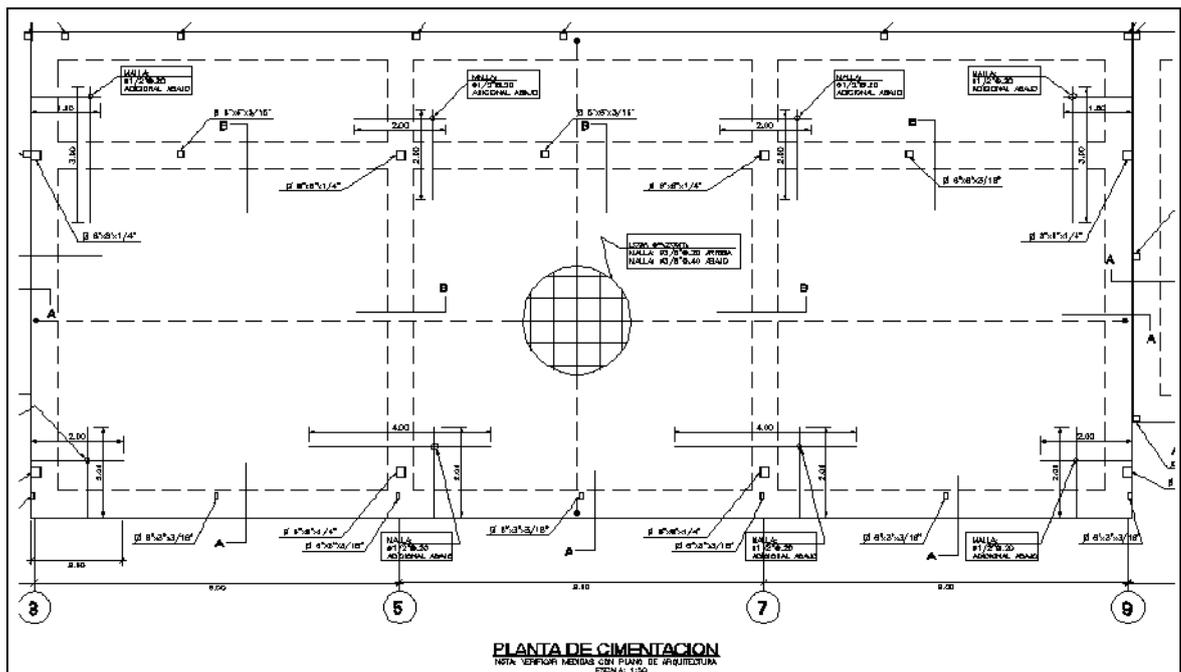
Cimentación propuesta. FUENTE: Elaboración Propia
